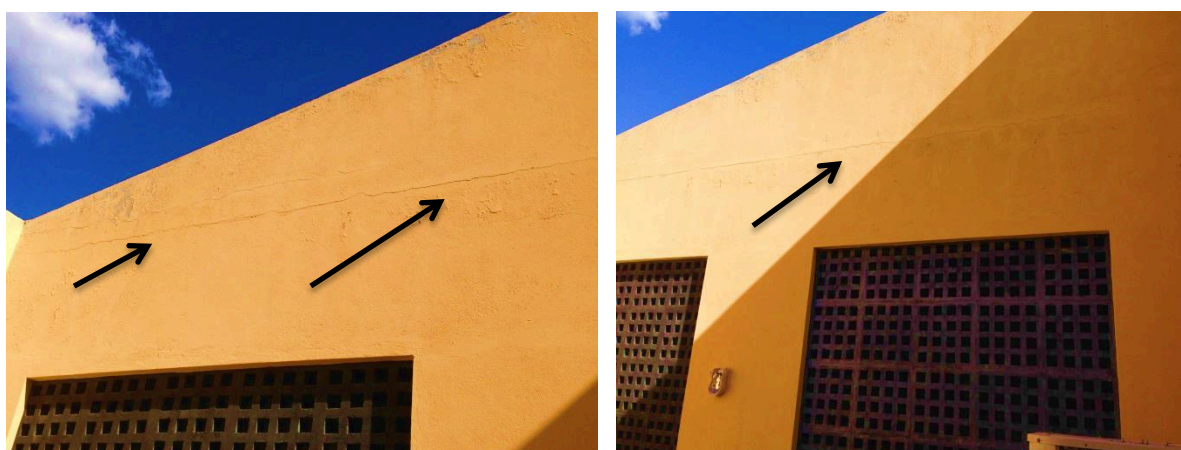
Fissuras causadas por movimentação térmica
